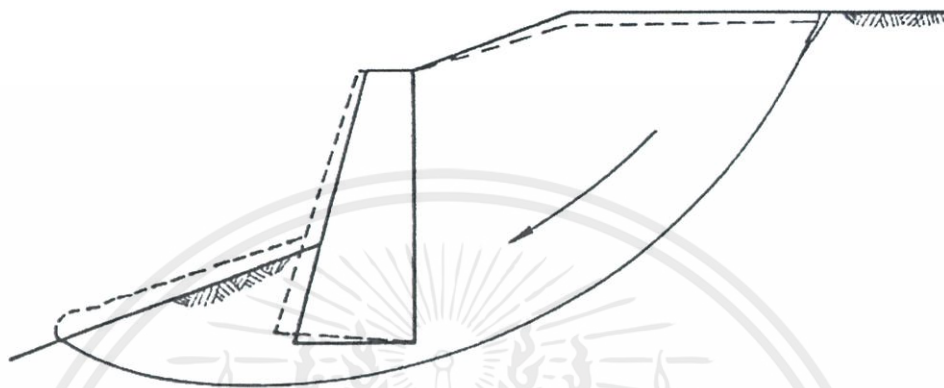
ลักษณะการพังทลายของกำแพงกันดินในรูปแบบ Structural Failure
